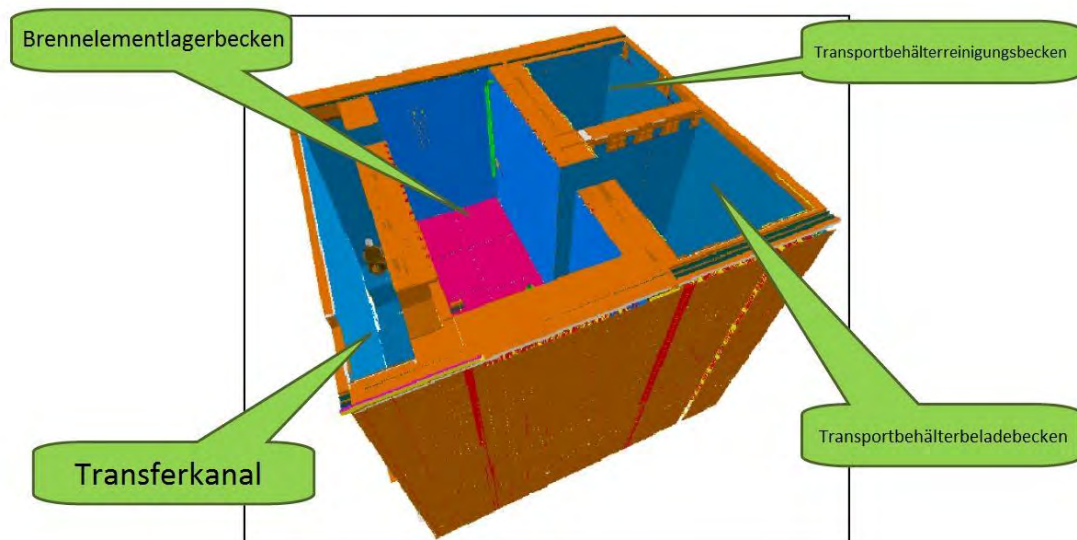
AP1000 - Brennelementlagerbecken mit Verbindung zu benachbarten Becken /AP 11c/
